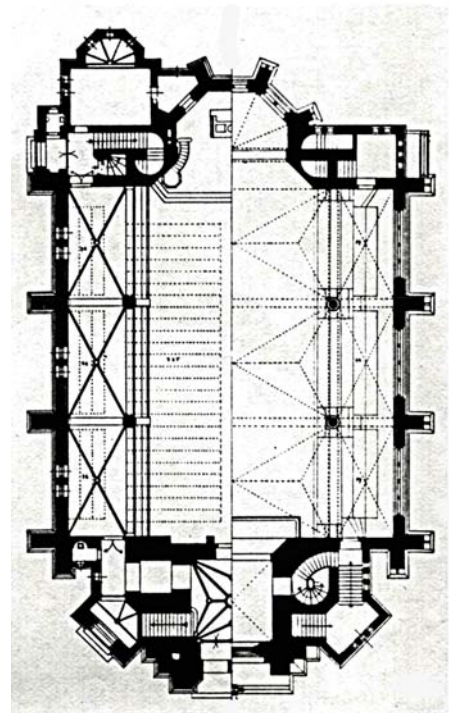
Grundriss Erd-/Emporengeschoss
